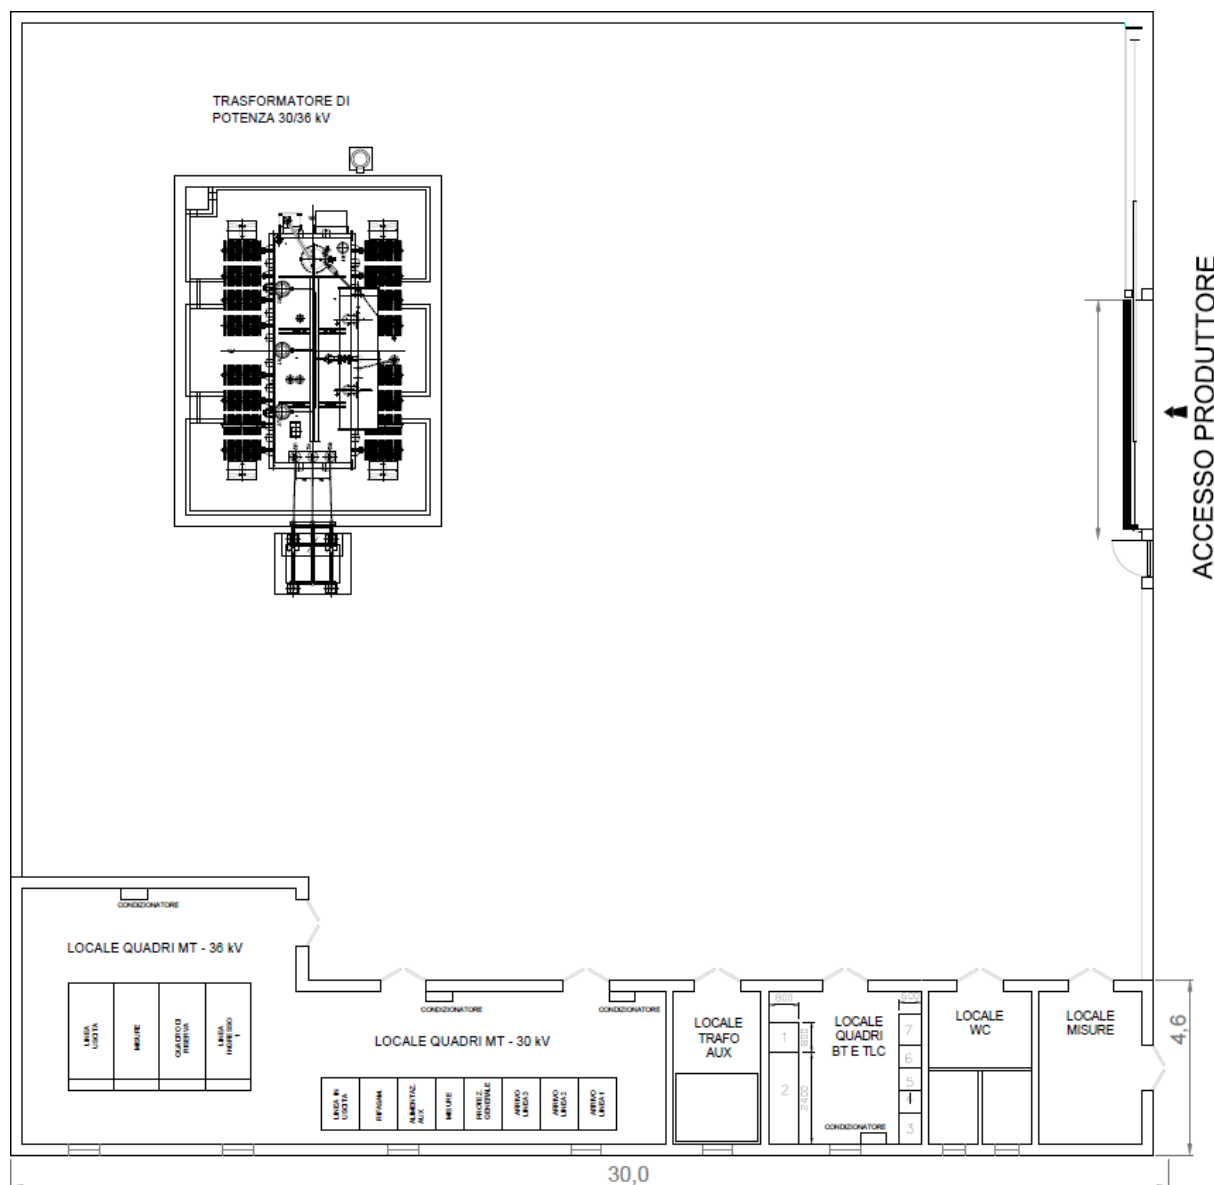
Planimetria elettromeccanica della stazione utente di trasformazione 30/36 kV
